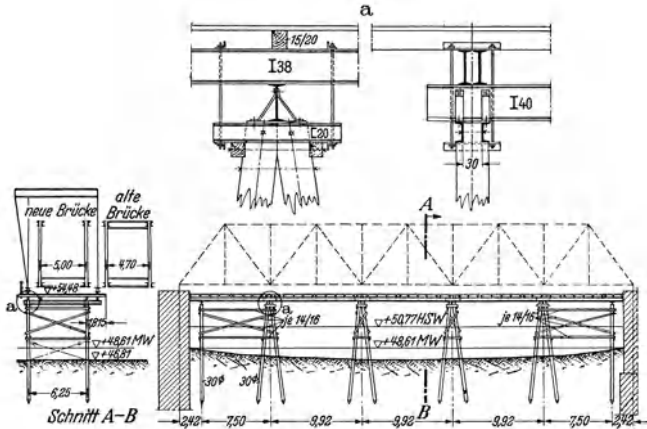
Aufstellgerüst der Oderbrücke bei Pommerzig.
